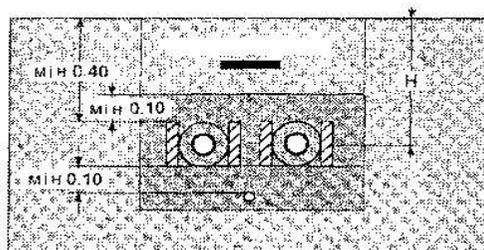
Поперечное сечение засыпанной двухпроводной сети трубопроводов в месте установки компенсационных подушек.
